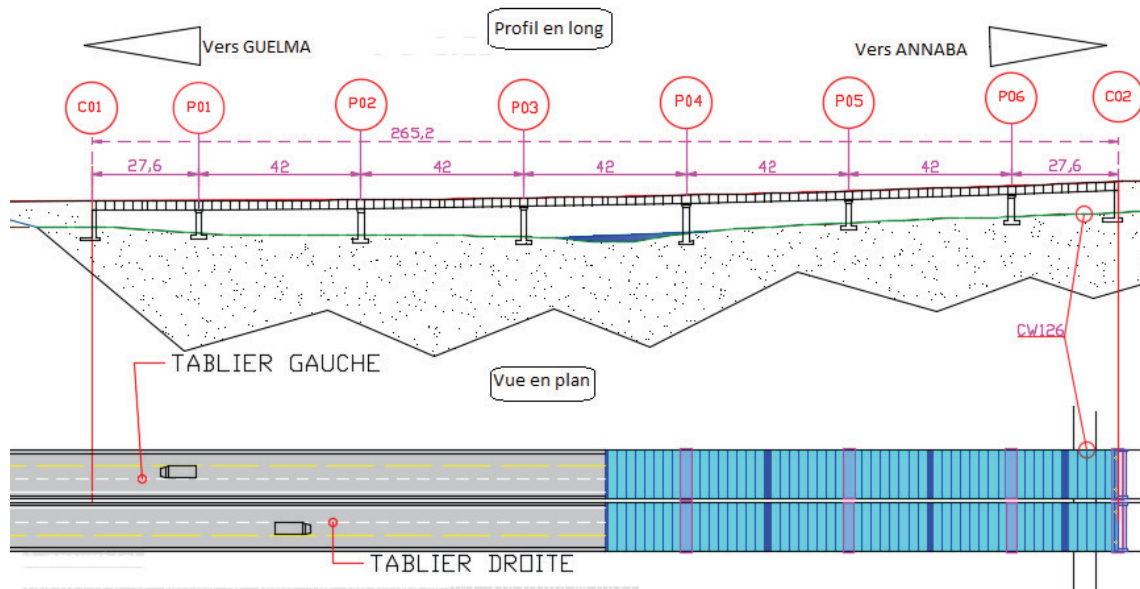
Coupe longitudinale et vue en élévation de la variante 3.
